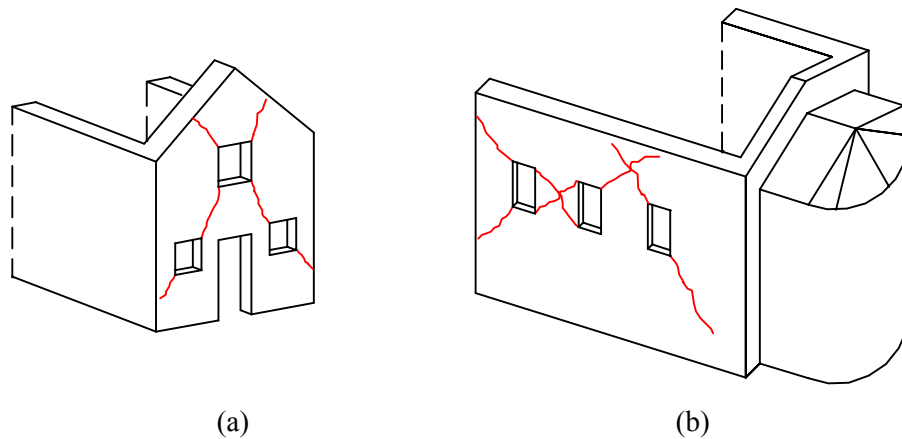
Danos no plano das paredes associados a mecanismos de corte (distorções): aparecimento de fendas inclinadas e/ou cruzadas na paredes.
